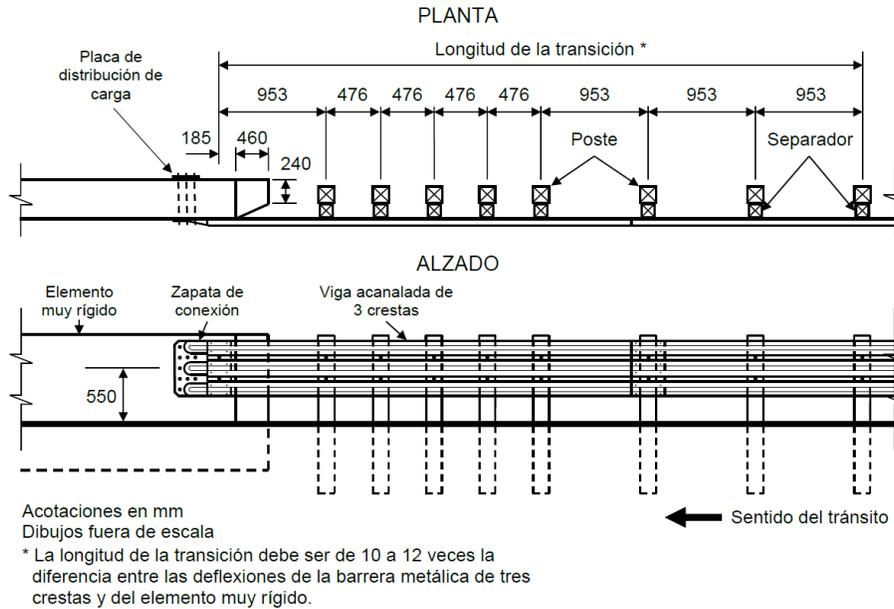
Transición de barrera metálica de tres crestas a muro vertical recto
